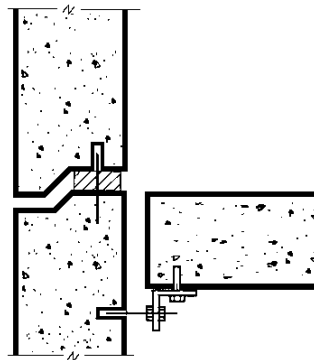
Ligação entre painéis de fachada e sua ligação à laje, adaptado de [35]
